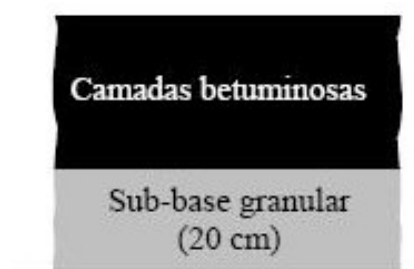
Pavimento flexível de base betuminosa (Picado-Santos, 2002)
